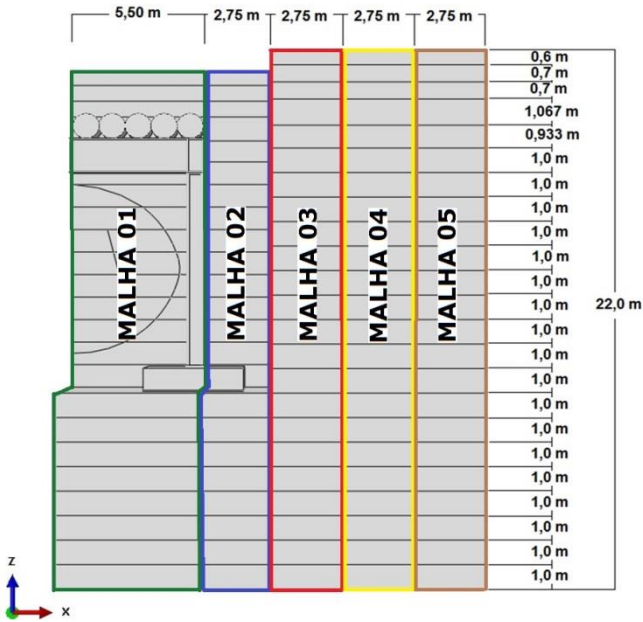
Configuração da malha para a escavação em Pórtico.
